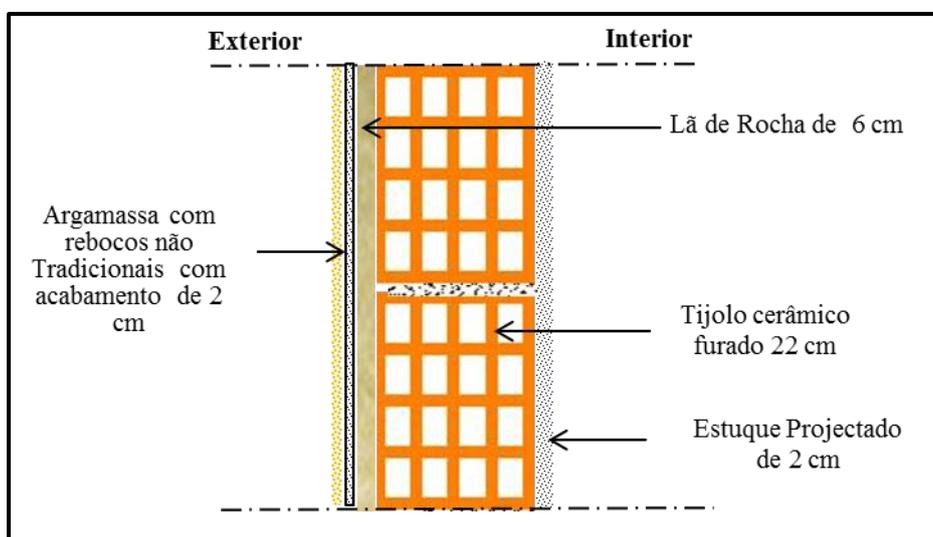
Pormenor Construtivo - PE com isolamento pelo Exterior – Lã de Rocha
